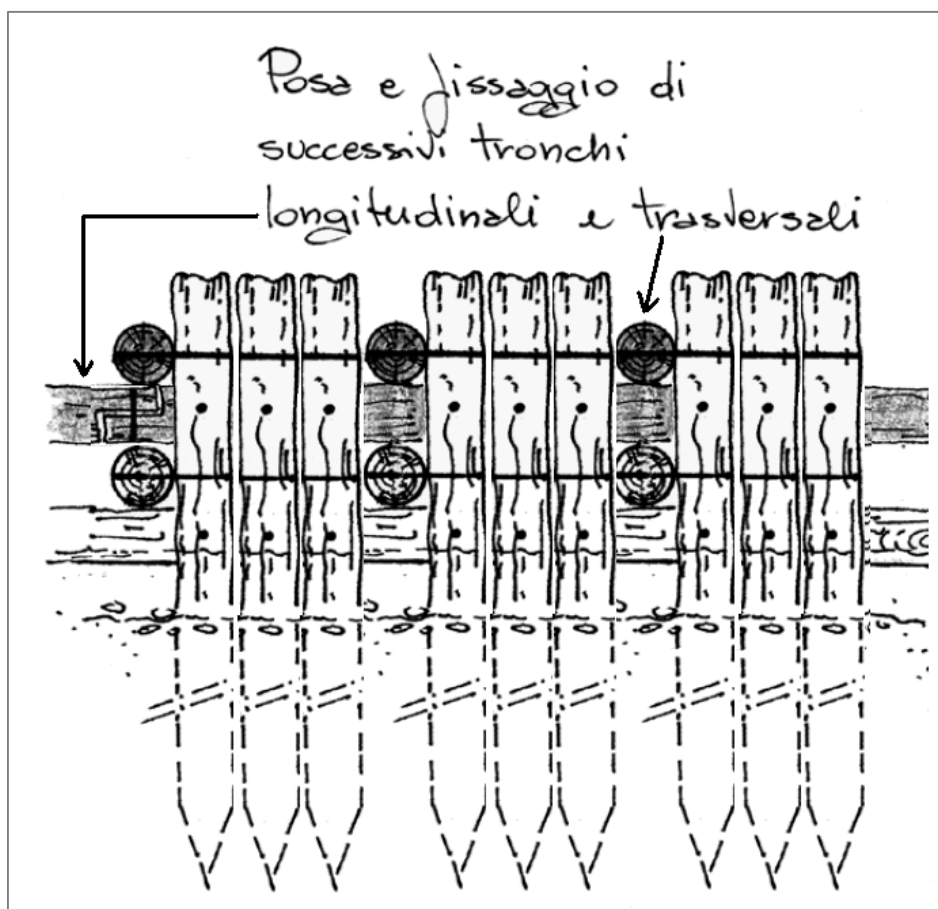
Posa secondo ordine di tronchi trasversali. Vista frontale
